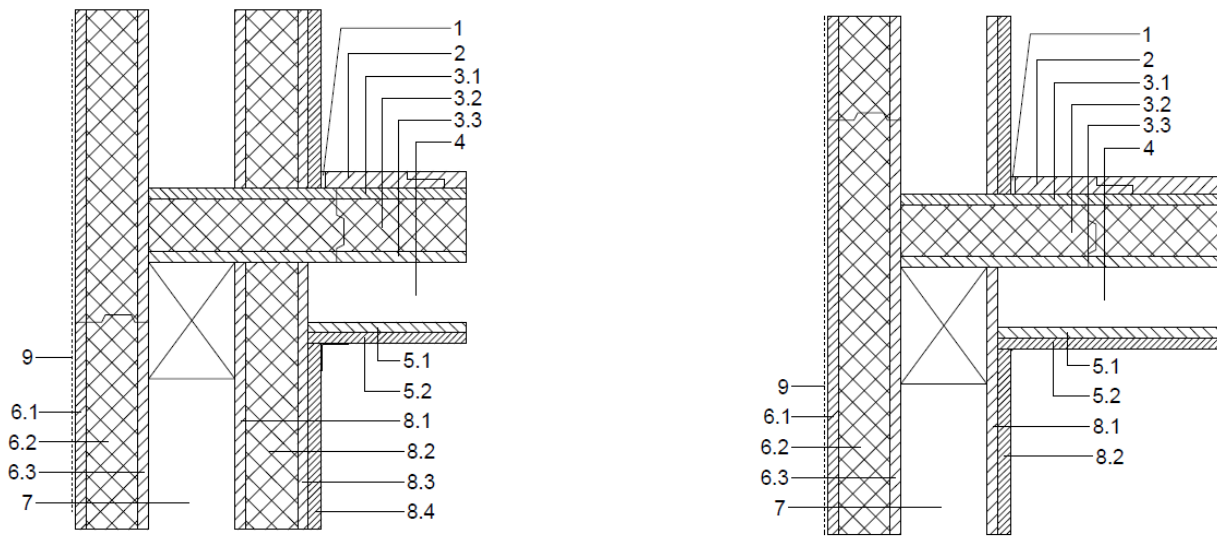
Encuentro tipo de fachada formada con paneles SATE y WALL con cubierta plana. Sección transversal vertical.
